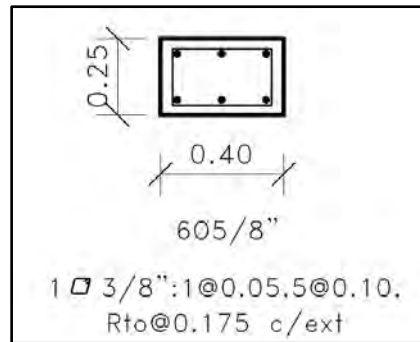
Armado final (estribos y acero longitudinal) de la columna central
